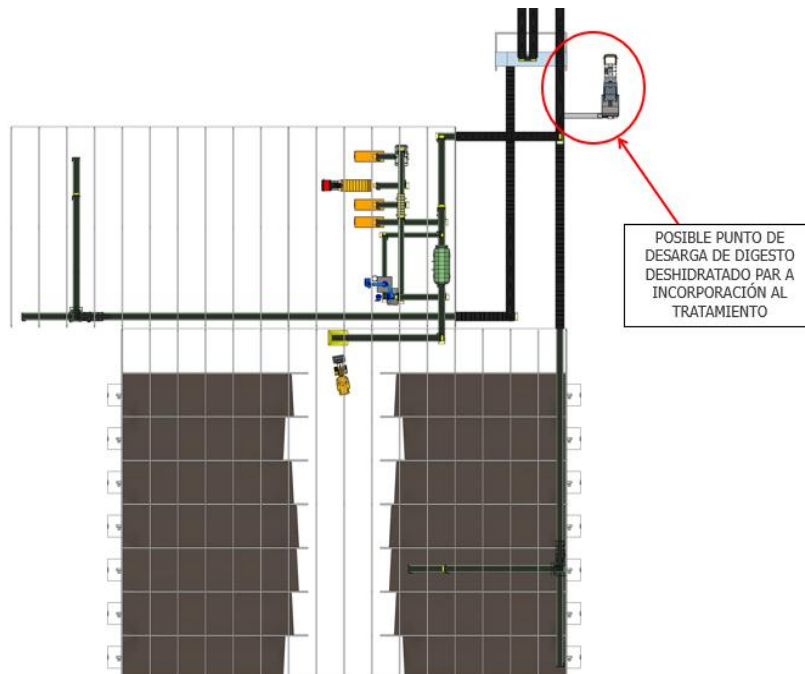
Alimentación de digesto deshidratado en la planta de biosecado
